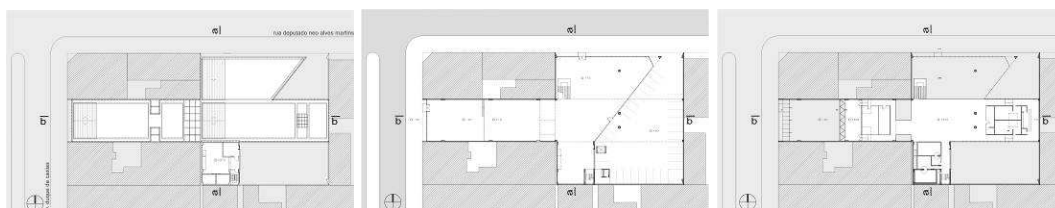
Planta de cobertura, térreo e primeiro pavimento. Fonte: Redesenho de Alves de Araujo com base nos projetos da PMM
